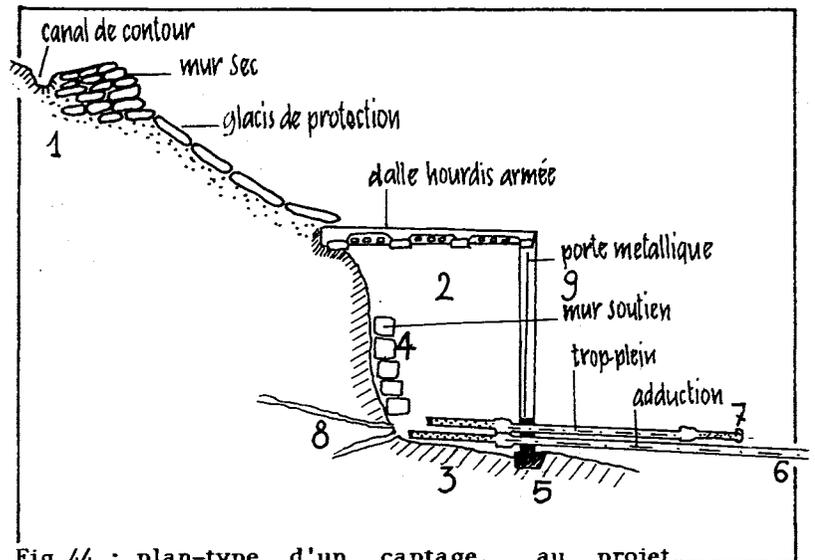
plan-typé d'un captage, au projet Jacmel (Haïti).
